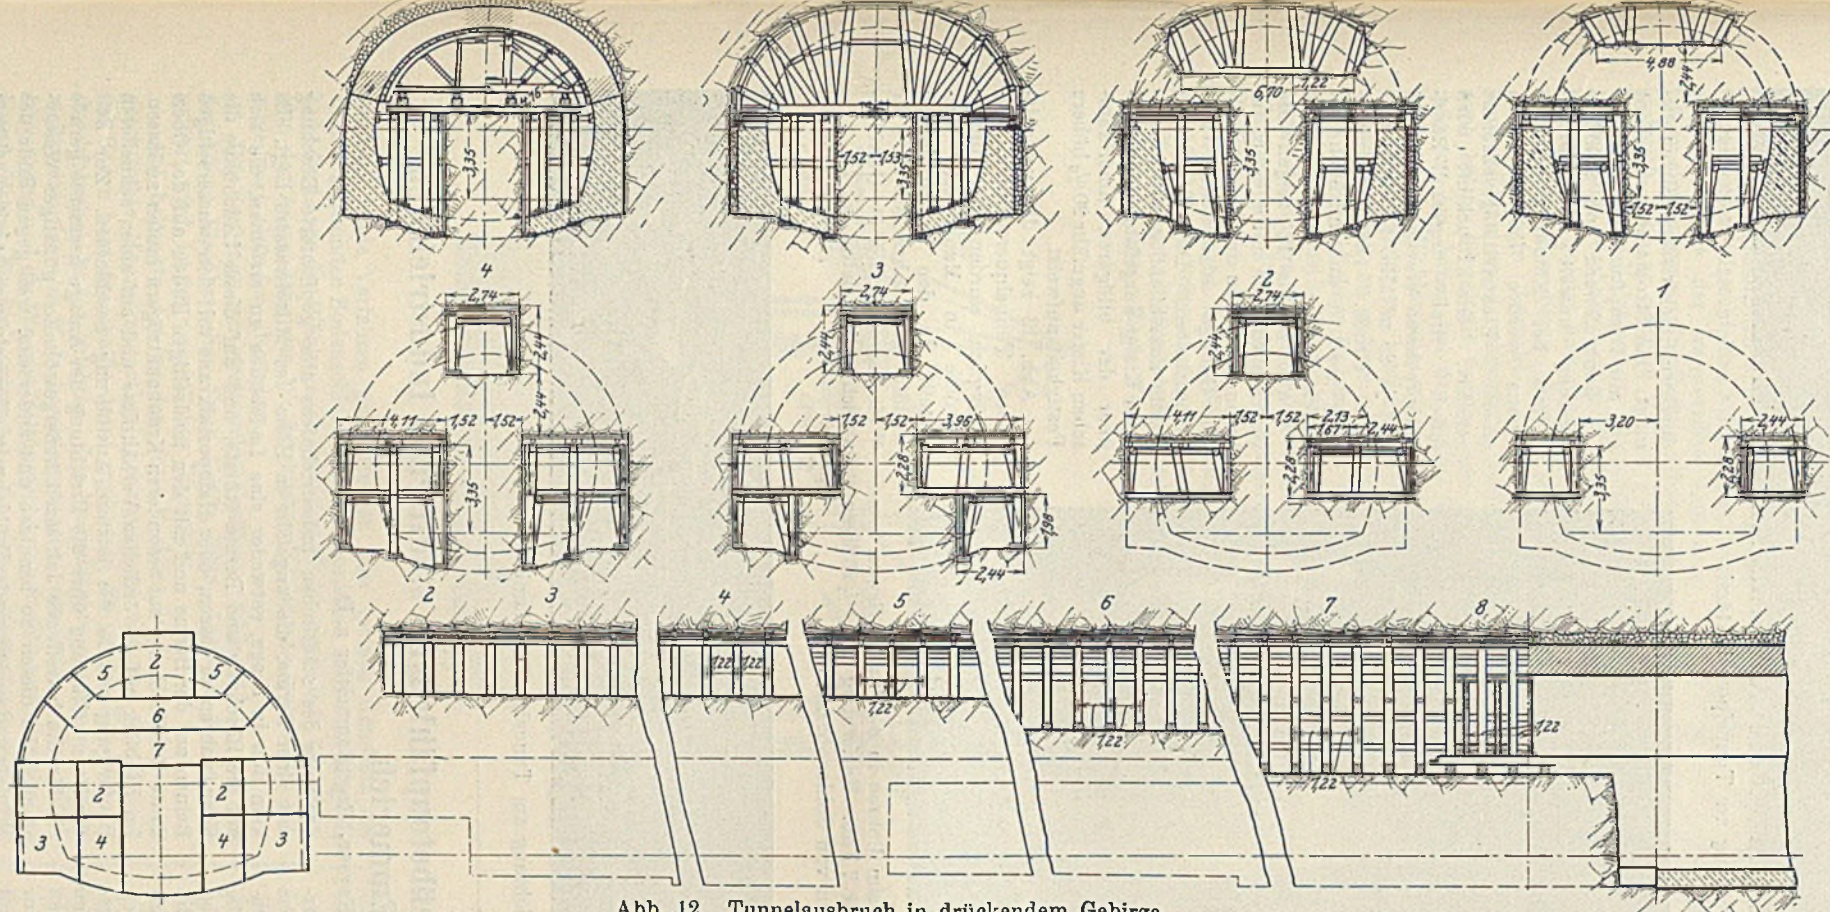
Tunnelausbruch in drückendem Gebirge.
